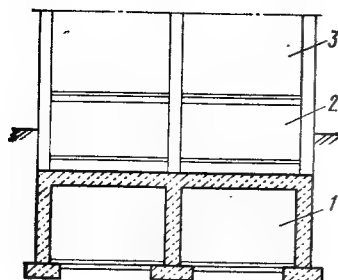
Поперечный разрез убежища, расположенного под техническим подпольем в жилом здании
